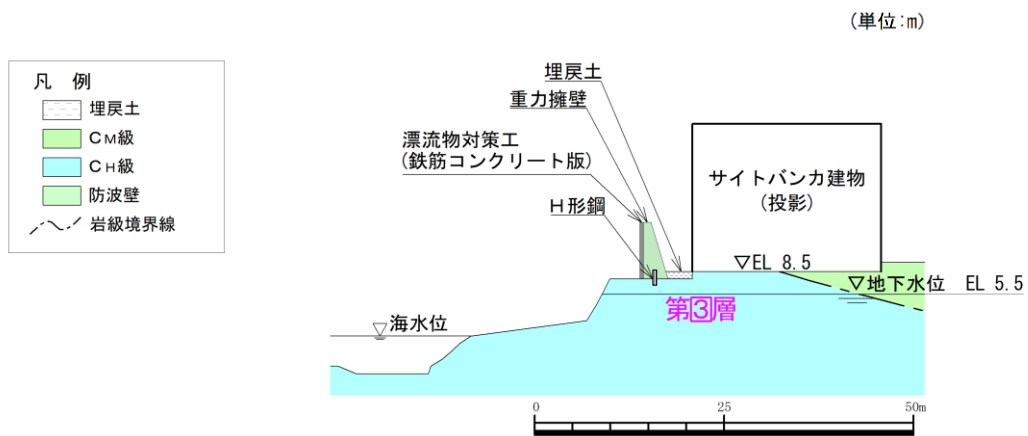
地質断面図 (⑤-⑤断面)
